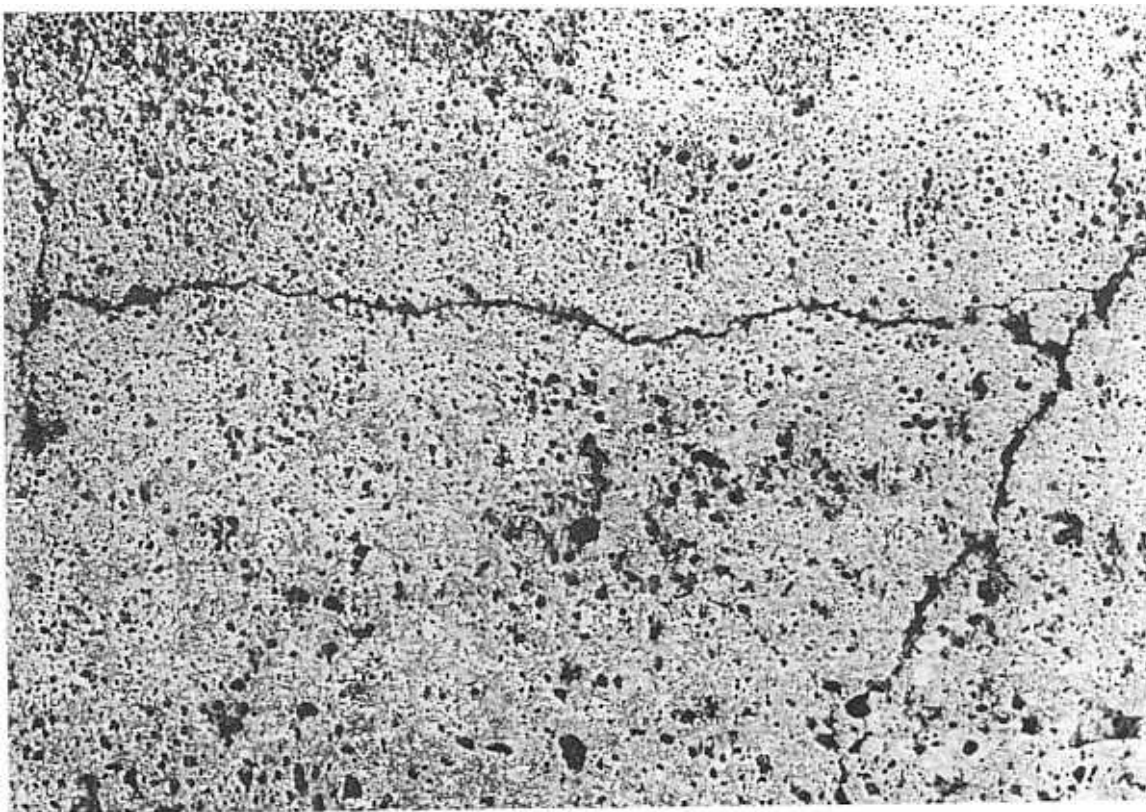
Riß in Gasbeton über verzinktem Bewehrungsstahl
